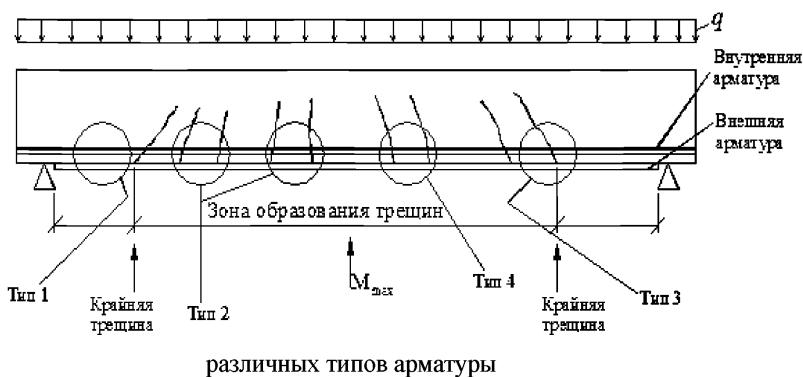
Типы разрушения железобетонной конструкции, усиленной КМФУ
